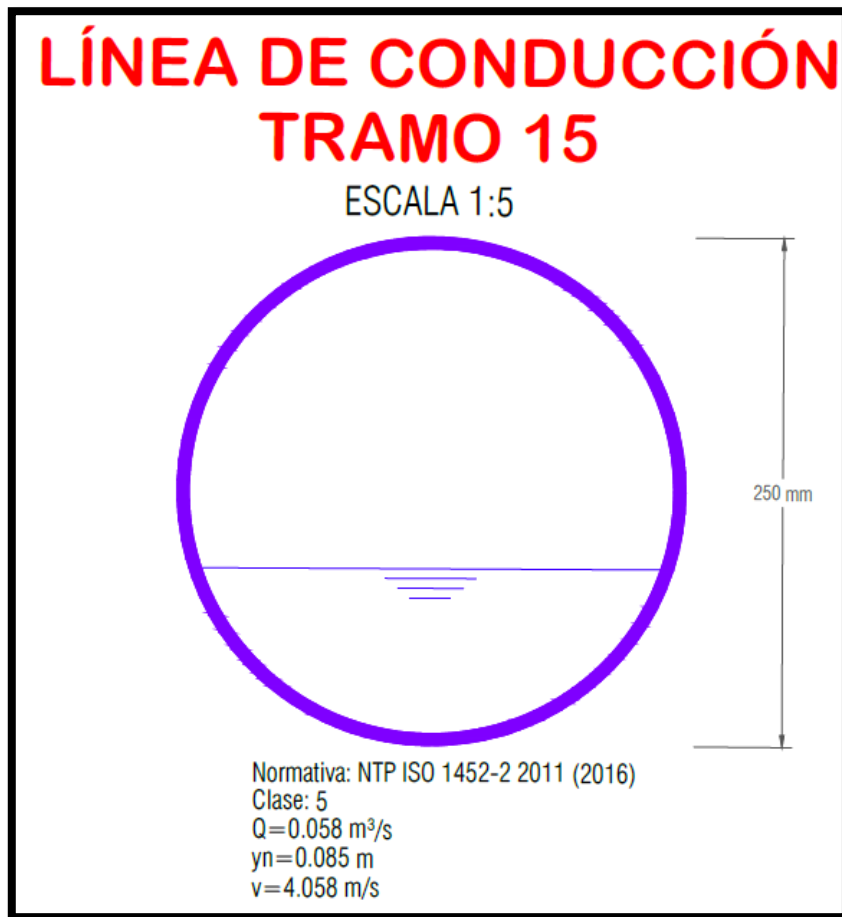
Sección típica de la tubería de PVC-U 250 mm, Tramo 15
